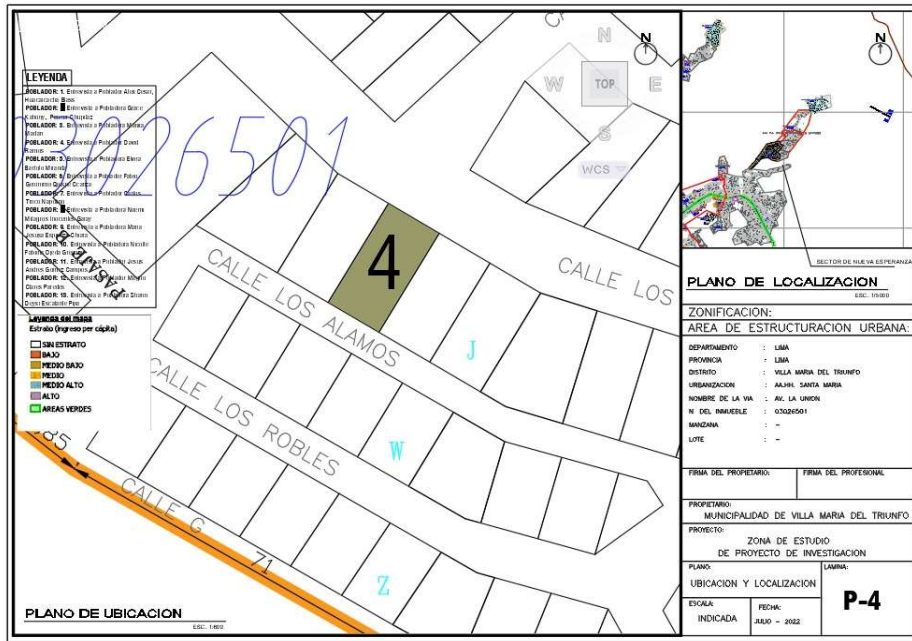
Plano de Ubicación de Casa de Señora vicepresidenta Marixa Madan
